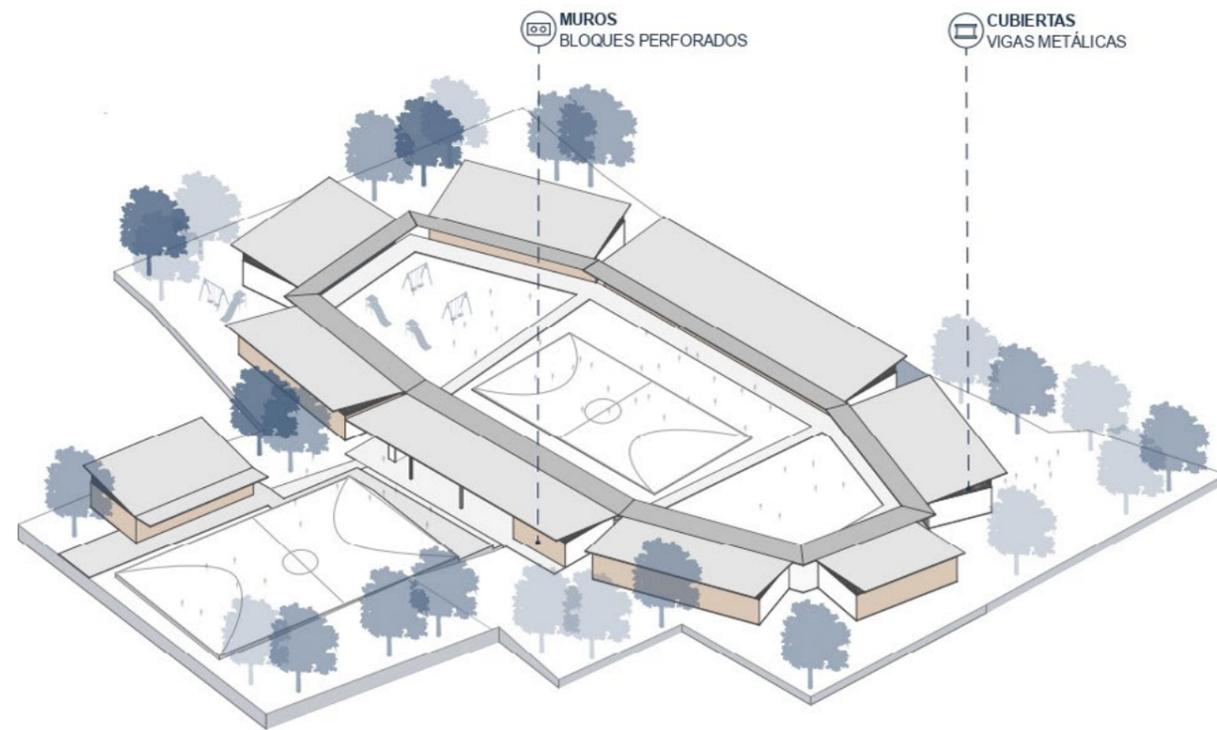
Sistema constructivo. Fuente: Elaboración propia, 2025.
